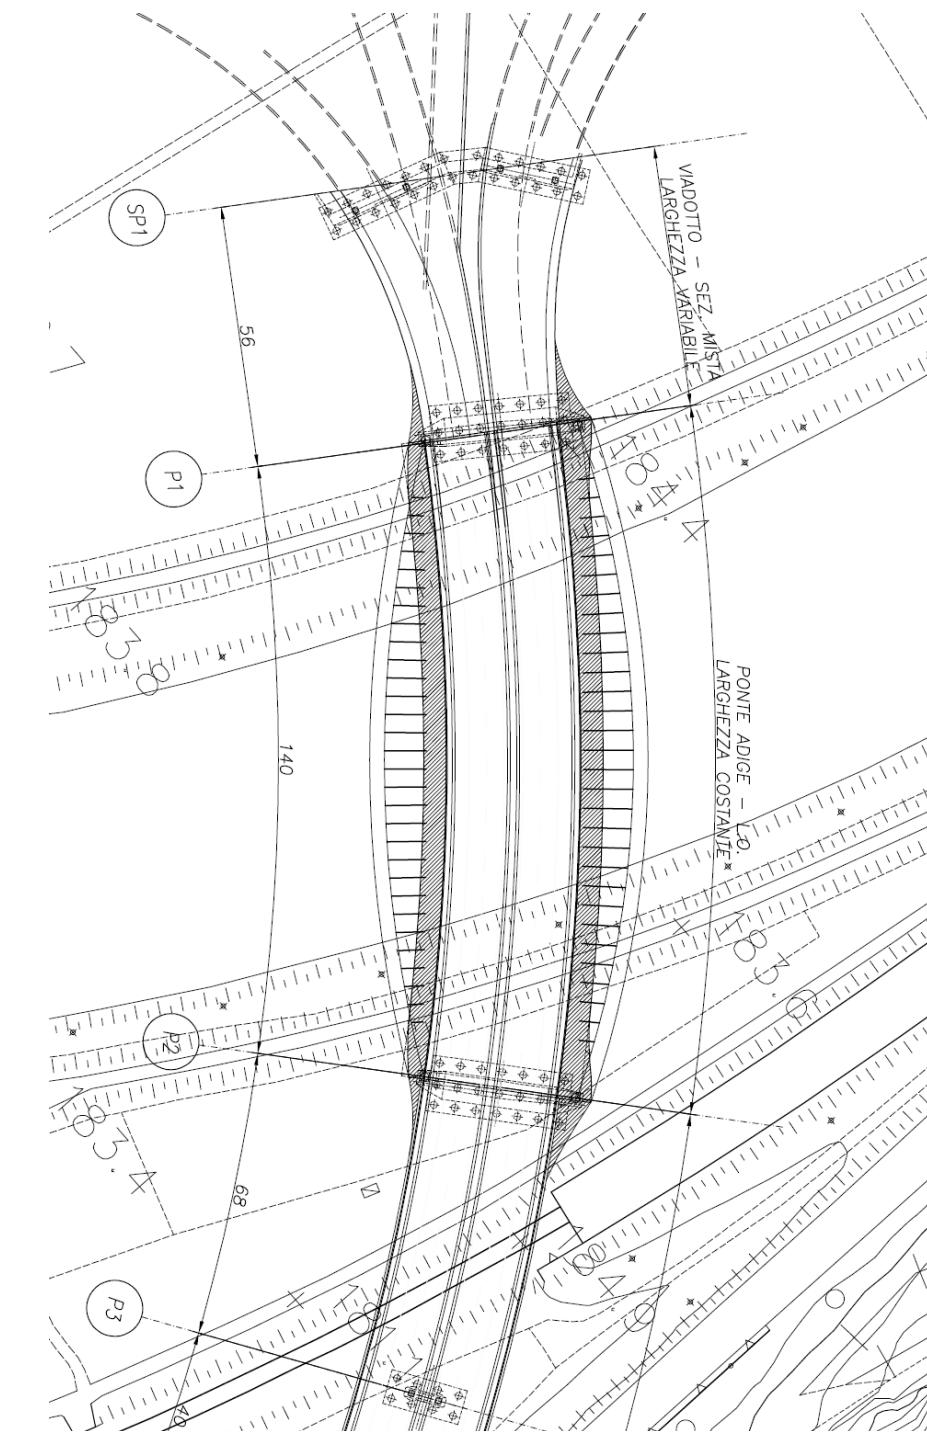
Stralcio planimetrico del tracciato in corrispondenza dell'opera
